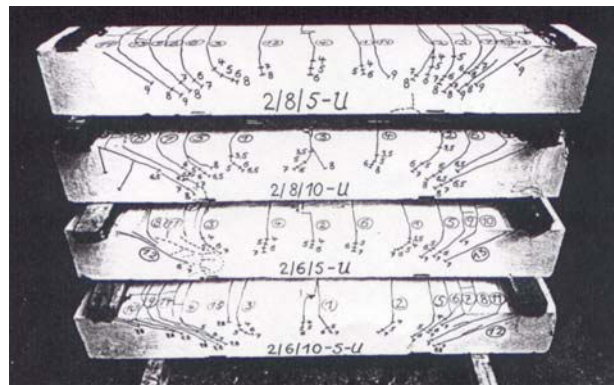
Rißbilder querkräftbewehrter Balkenelemente nach [jano_1]
